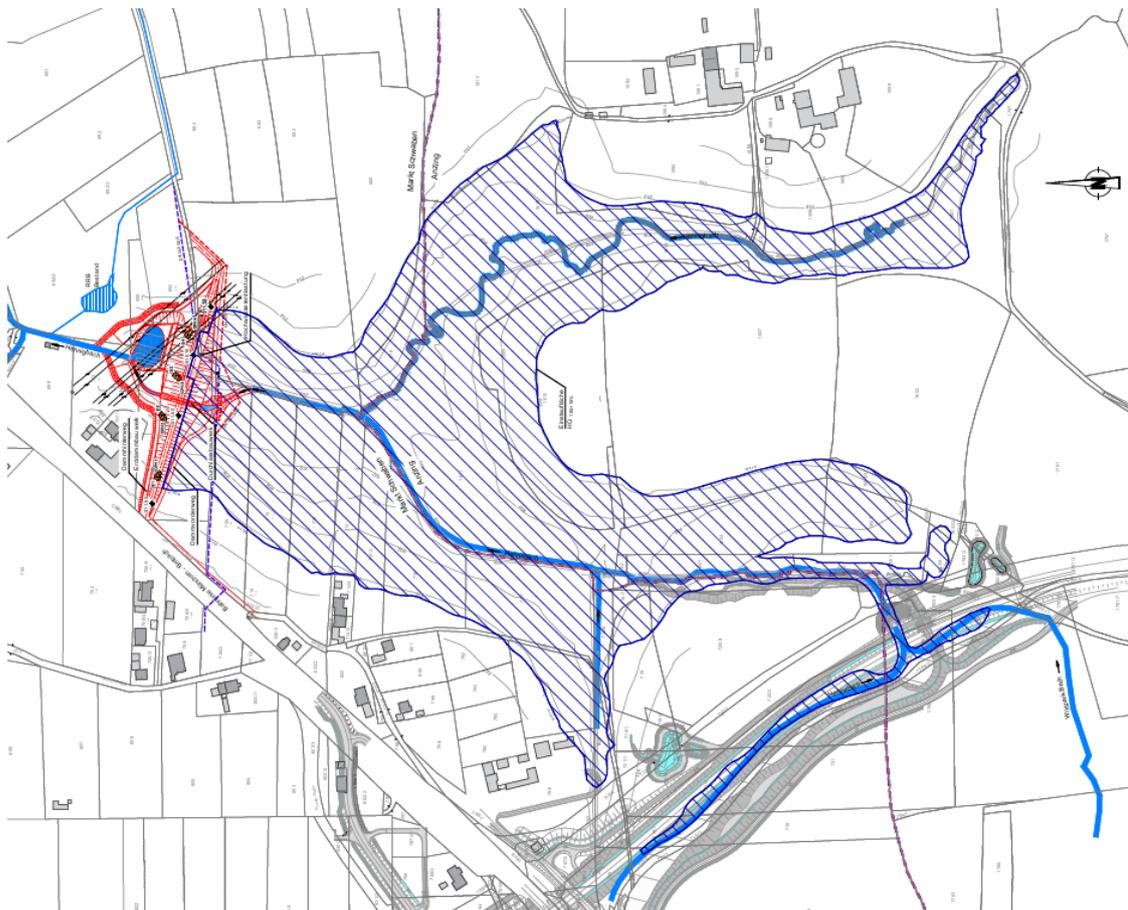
Lageplanausschnitt (gesamter Hochwasserrückhalteraum)
